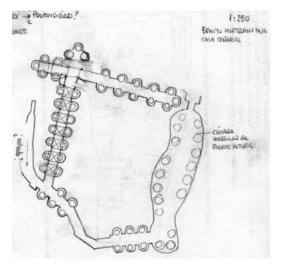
Esquema en planta de la cueva en la calle Benito Hortelano
